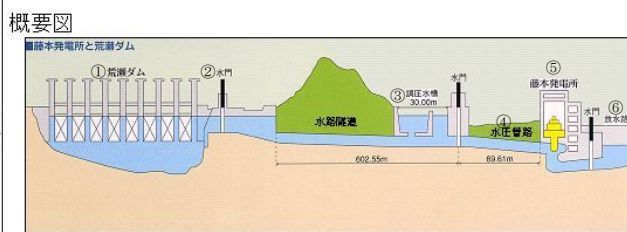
荒瀬ダム・藤本発電所の概要図
